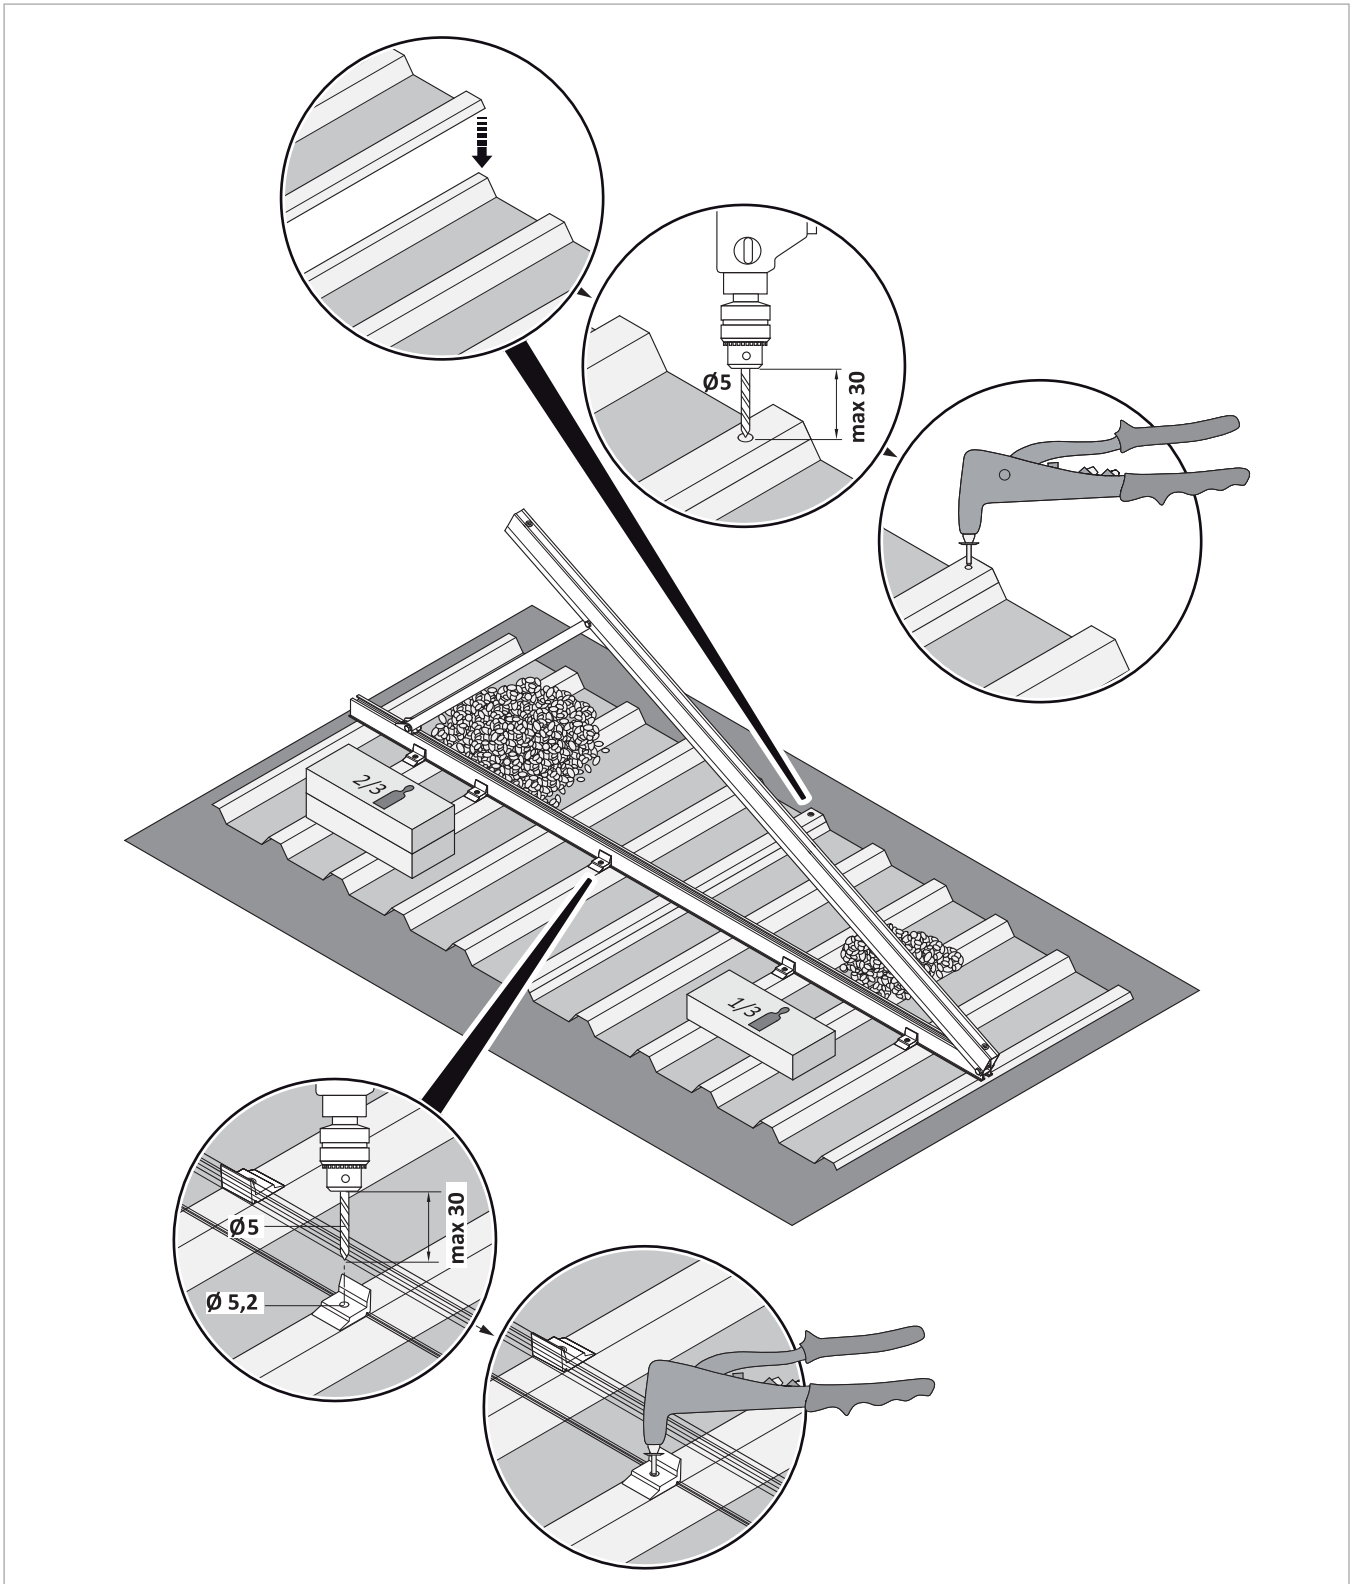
montaggio del supporto per tetto piano su lamiera trapezoidale
